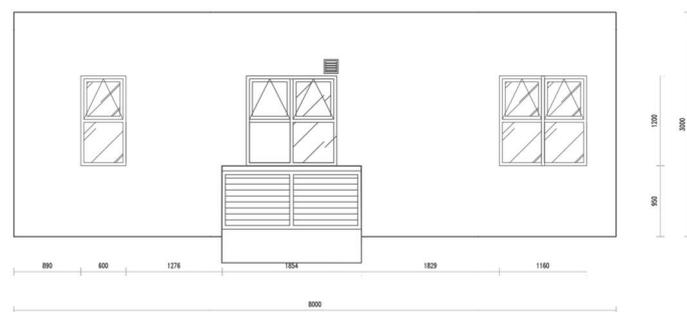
Denah fasad unit 1A (sumber: dokumen pengelola)
